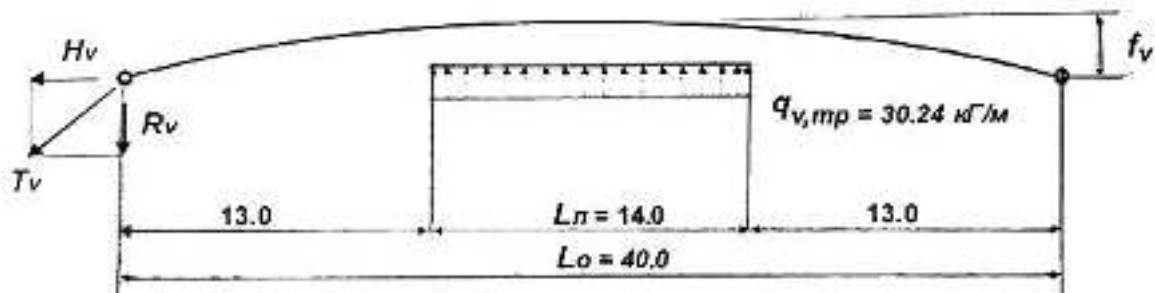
Расчетная схема нити для определения усилий от ветровой нагрузки на транспарант
